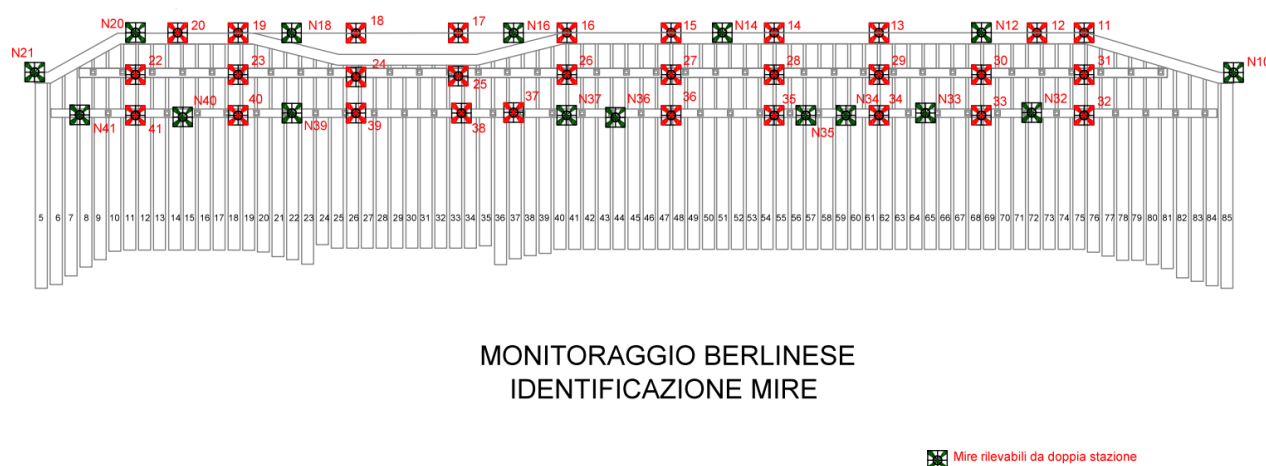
Prospetto con aggiunta nuove mire rilevabili da doppia stazione
